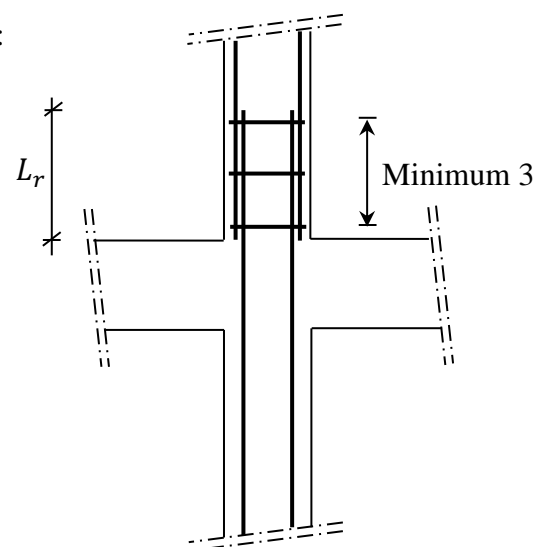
Les armatures transversales dans la zone de recouvrement.
